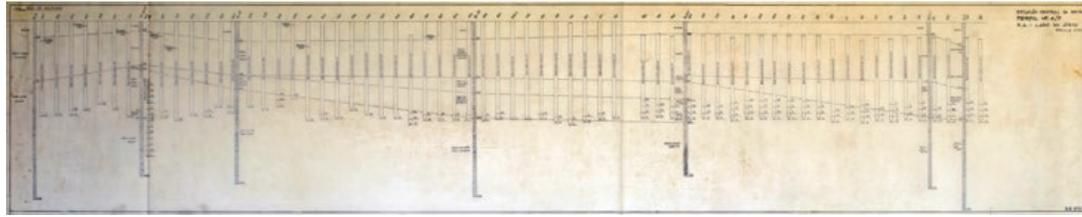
Brigada de Melhoramentos, Estação Central da Beira / Improvement Brigade, Beira Central Station (1957-1966), Perfil N° 4/7, Lado do átrio / Profile no. 4/7, E. A. Atrium side (s.d./n.d.)
